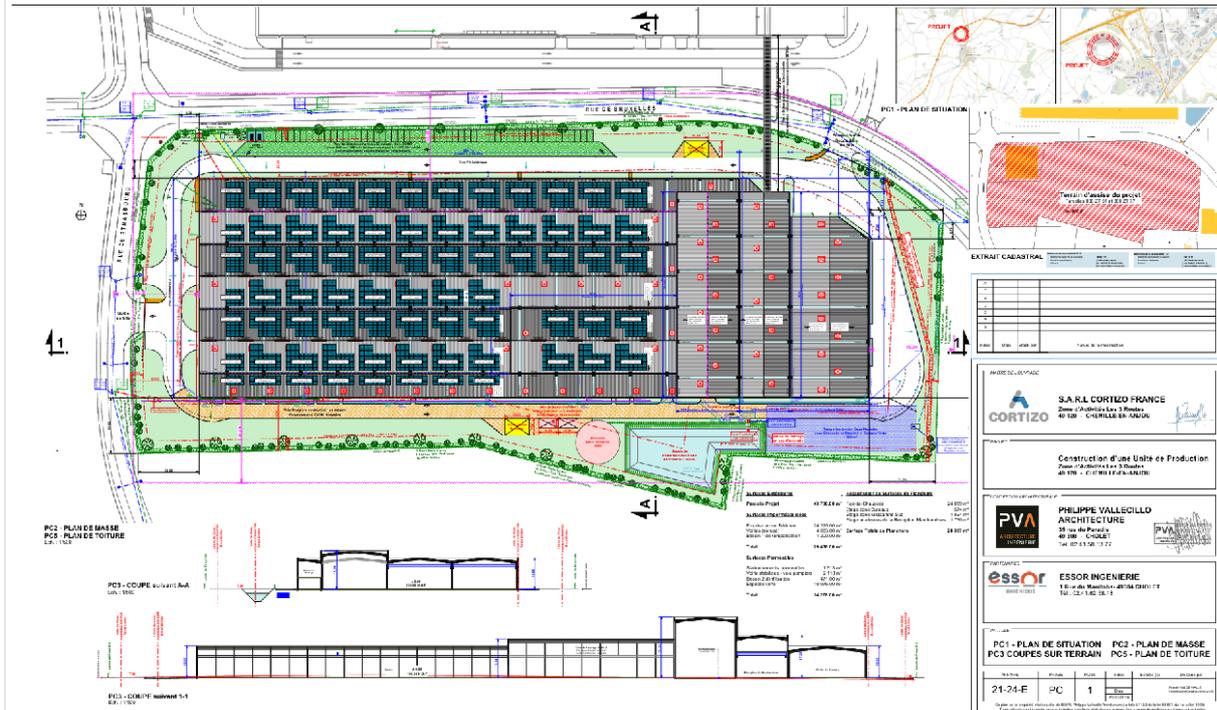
Plan masse du projet d'extension de l'entreprise Cortizo (version 15 janvier 2025)
